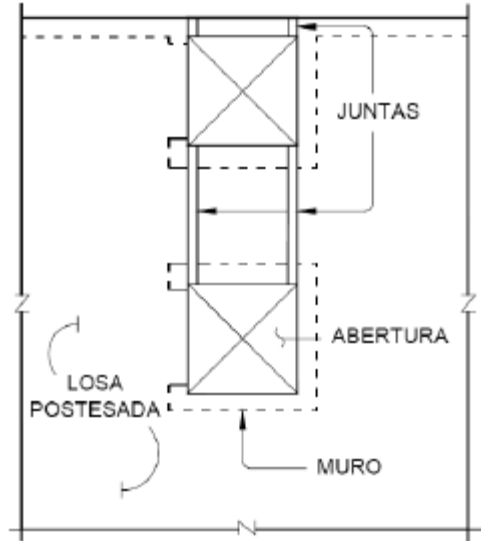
c. Secciones de losa aisladas. [A2]
